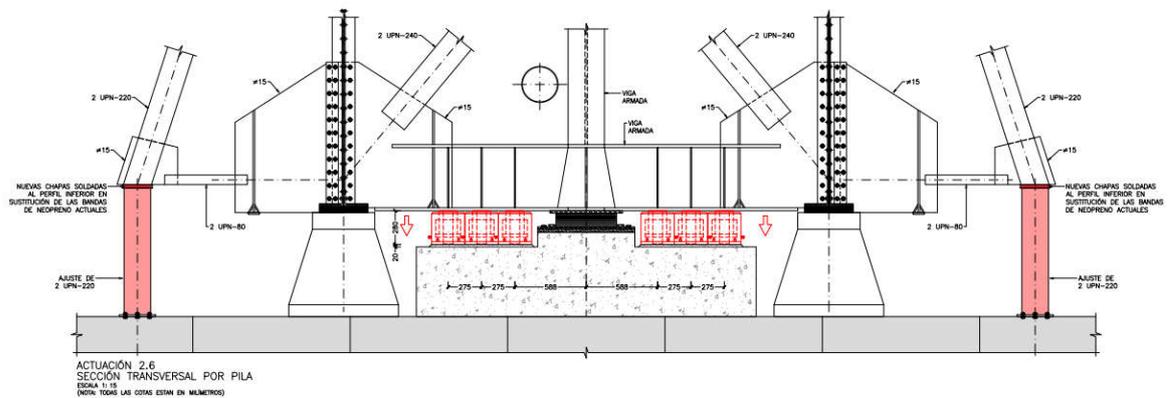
Retirada de gatos y soldado de chapas en apoyos de contravientos
